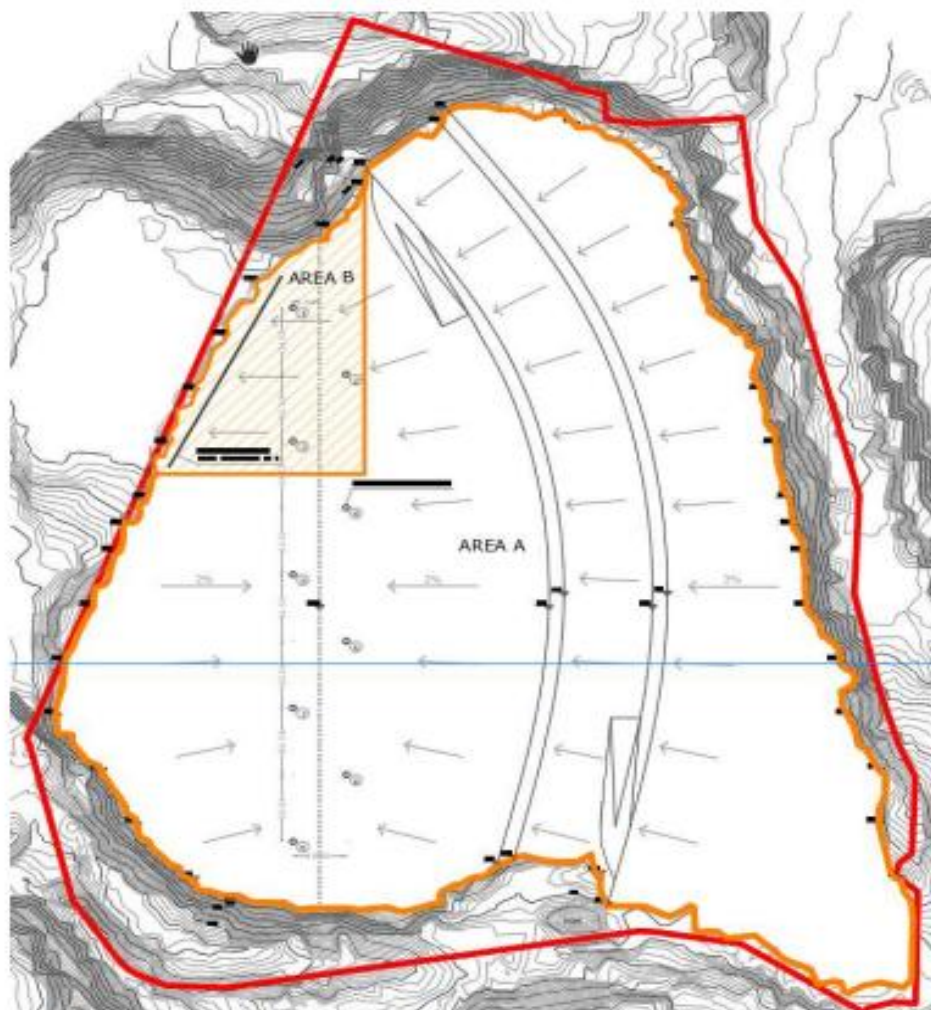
Planimetria di progetto. In rosso la perimetrazione catastale, in arancione l'area di intervento.
